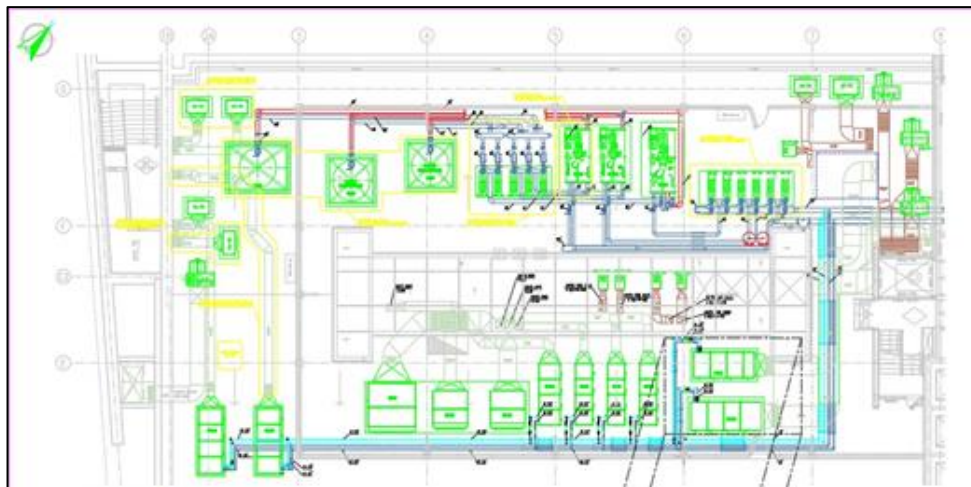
Vista en planta de la central de frío del Proyecto.
